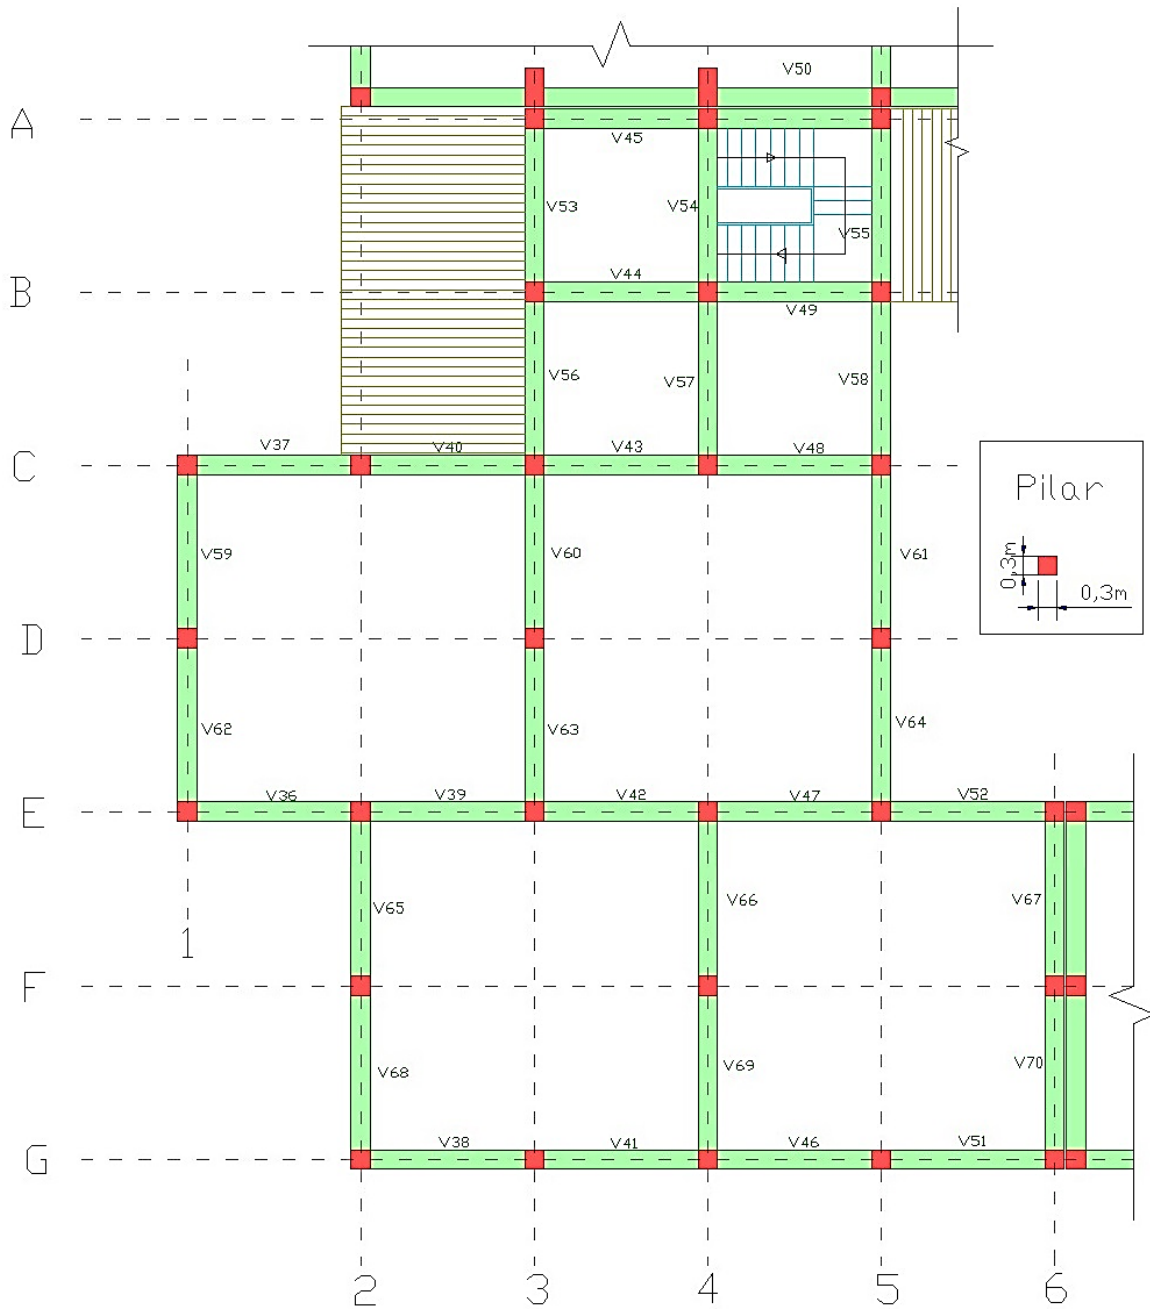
Planta estrutural do andar, do corpo em estudo, da Escola Básica da Portela.
